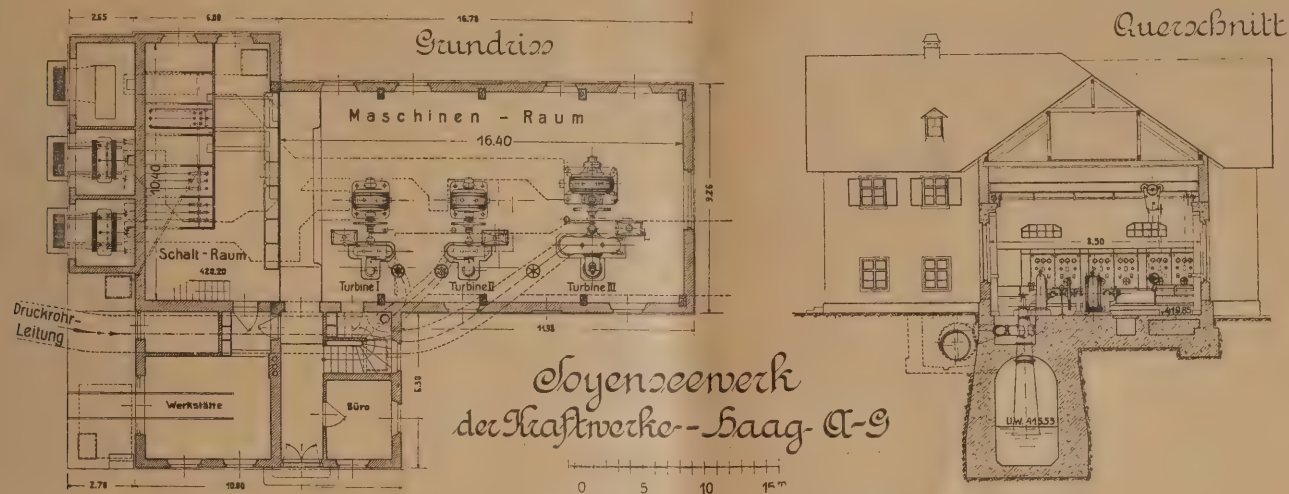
u. 8. Grundriß und Querschnitt vom Krafthaus.
